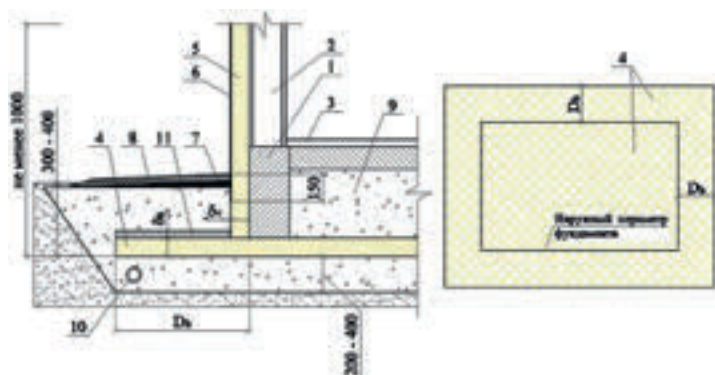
Схема укладки и параметры теплоизоляции URSA XPS в фундаментах зданий с переменным режимом эксплуатации (отапливаемое – неотапливаемое)
